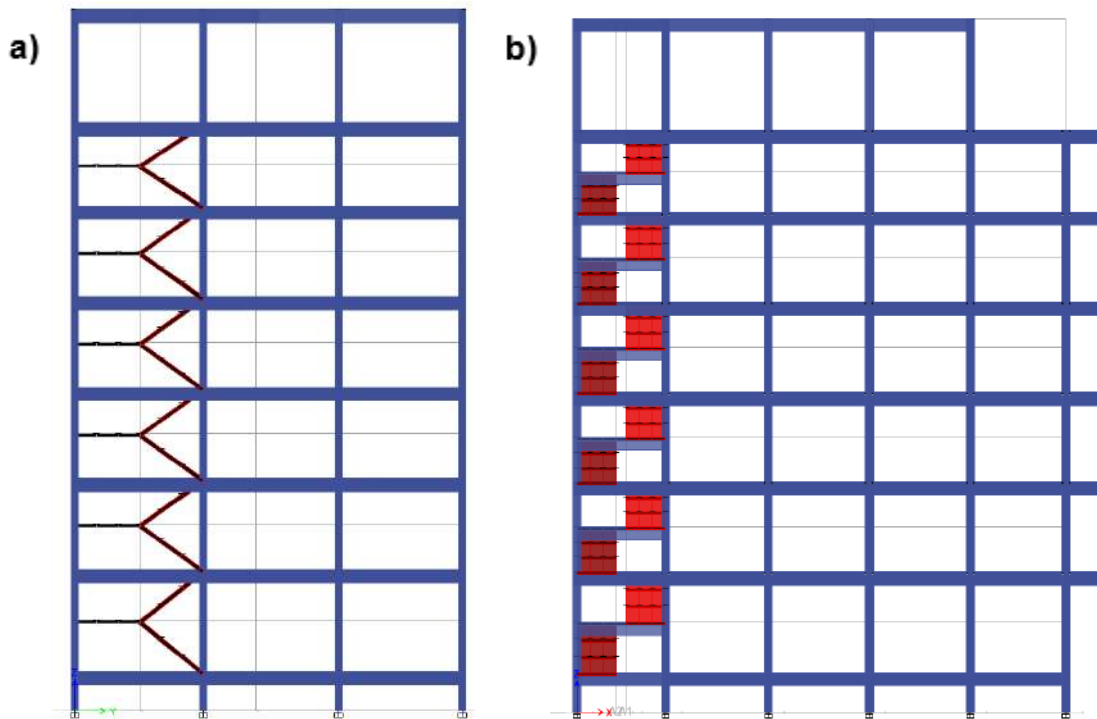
Modelo Estructural a) Vista Frontal b) Vista Lateral
